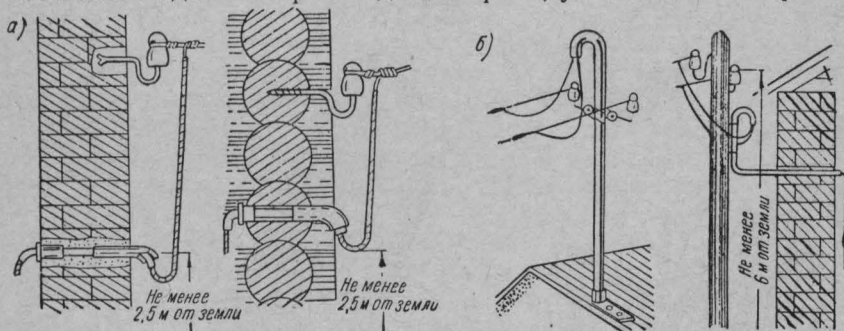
Вводы в здание электрических проводок: а) через кирпичную и деревянные стены; б) через крышу и с подставным столбом
